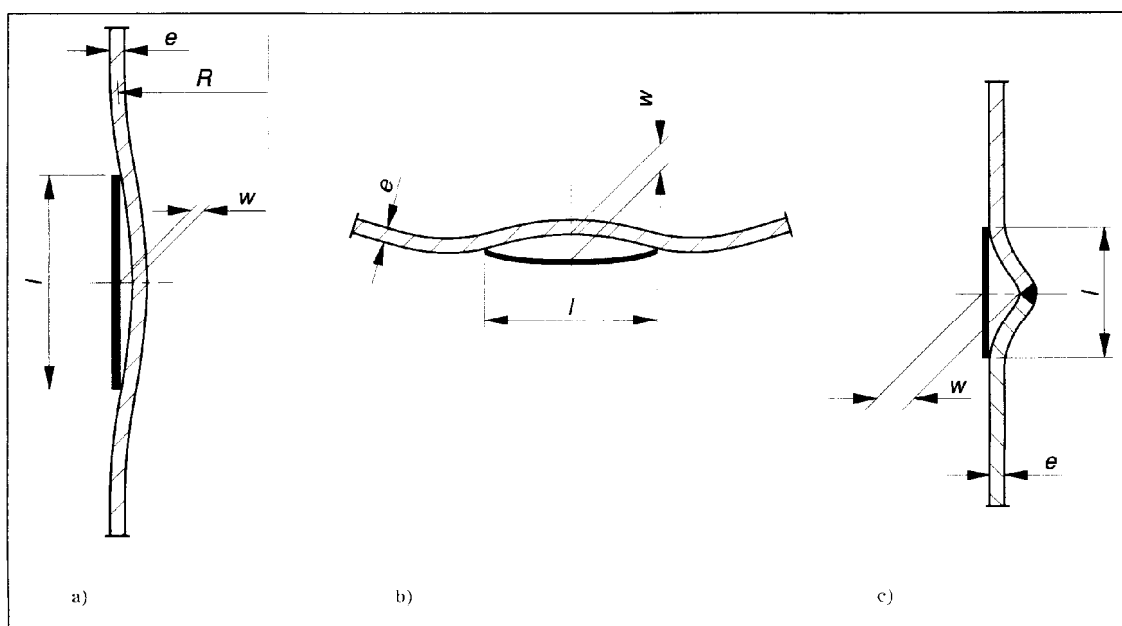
Plantillas para comprobar tolerancias
